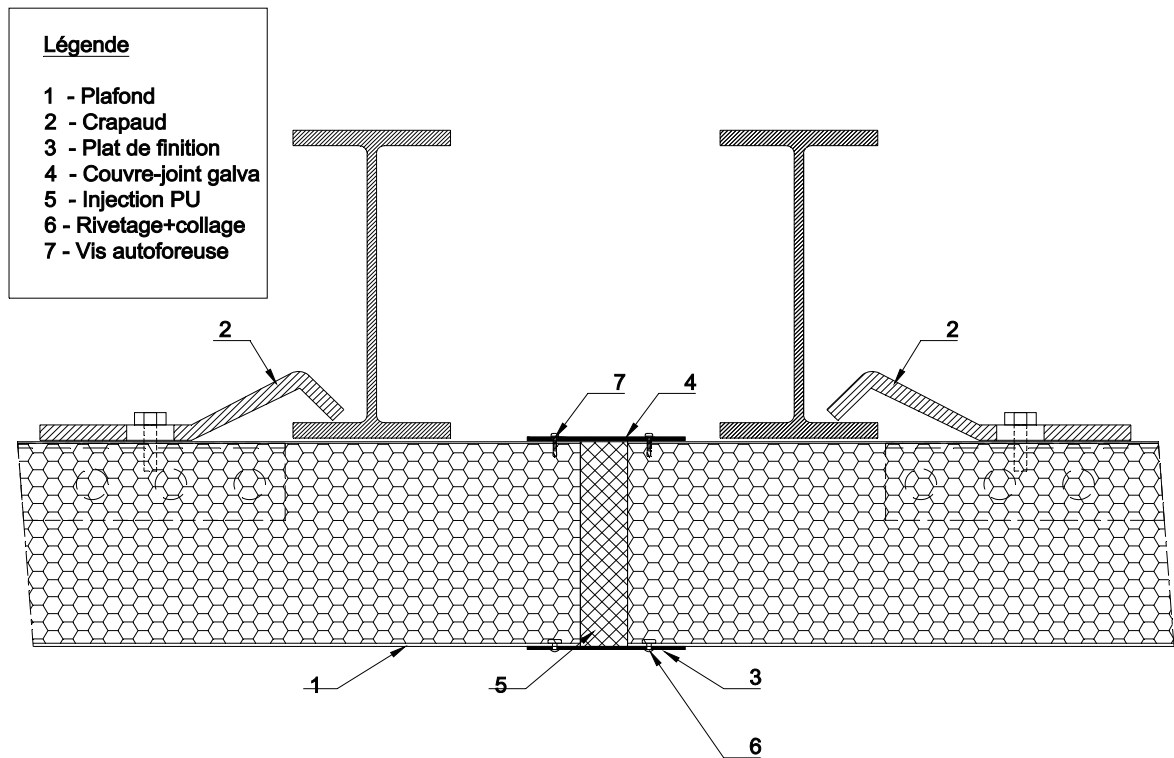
Fixation par crapauds et inserts - Liaison (minimum 2 vis Ø 4,2 mm par largeur de panneau) entre le panneau et les couvre-joint.
